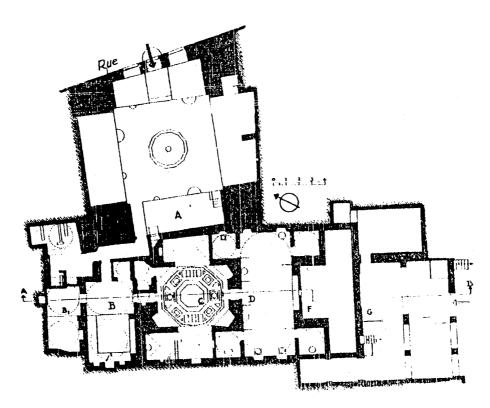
مسقط أفقي لقصر العظم في دمشق . (الطابق الأرضي) (عن : الريحاوي) .
